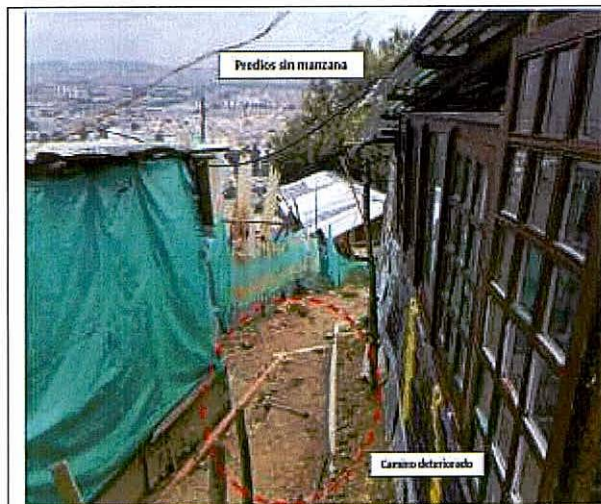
Vista de vía que da acceso a las viviendas en invasión.
